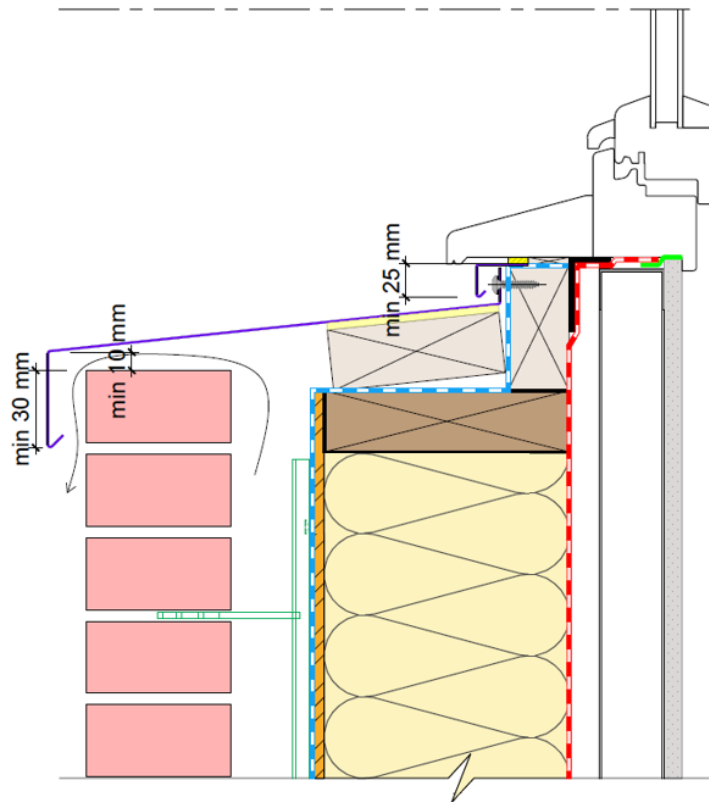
Exemple de conception entre mur maçonné, bavette d'appui et calfeutrement
